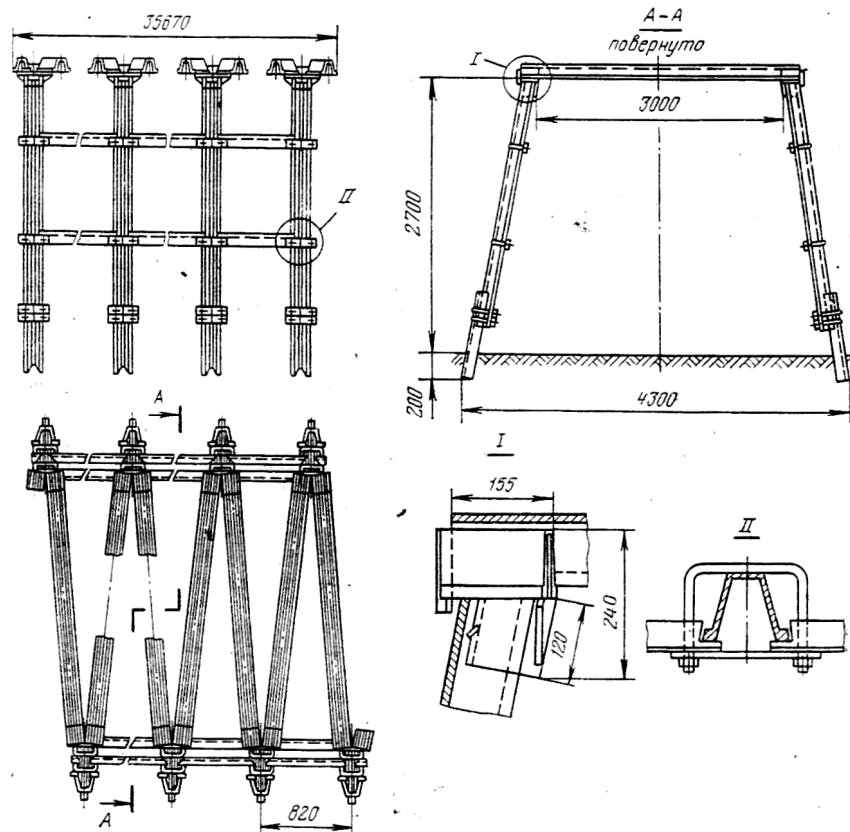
Конструкция с усиленным верхним перекрытием
